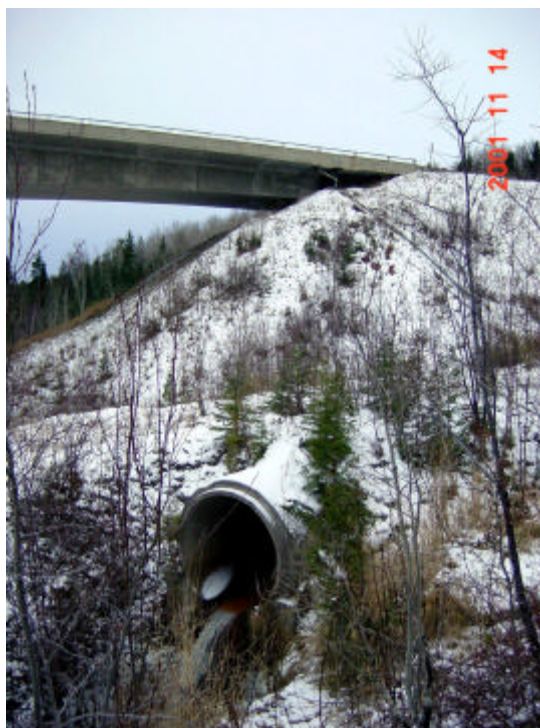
Sortie du réseau d'égout pluvial de l'autoroute Jean-Lesage.
